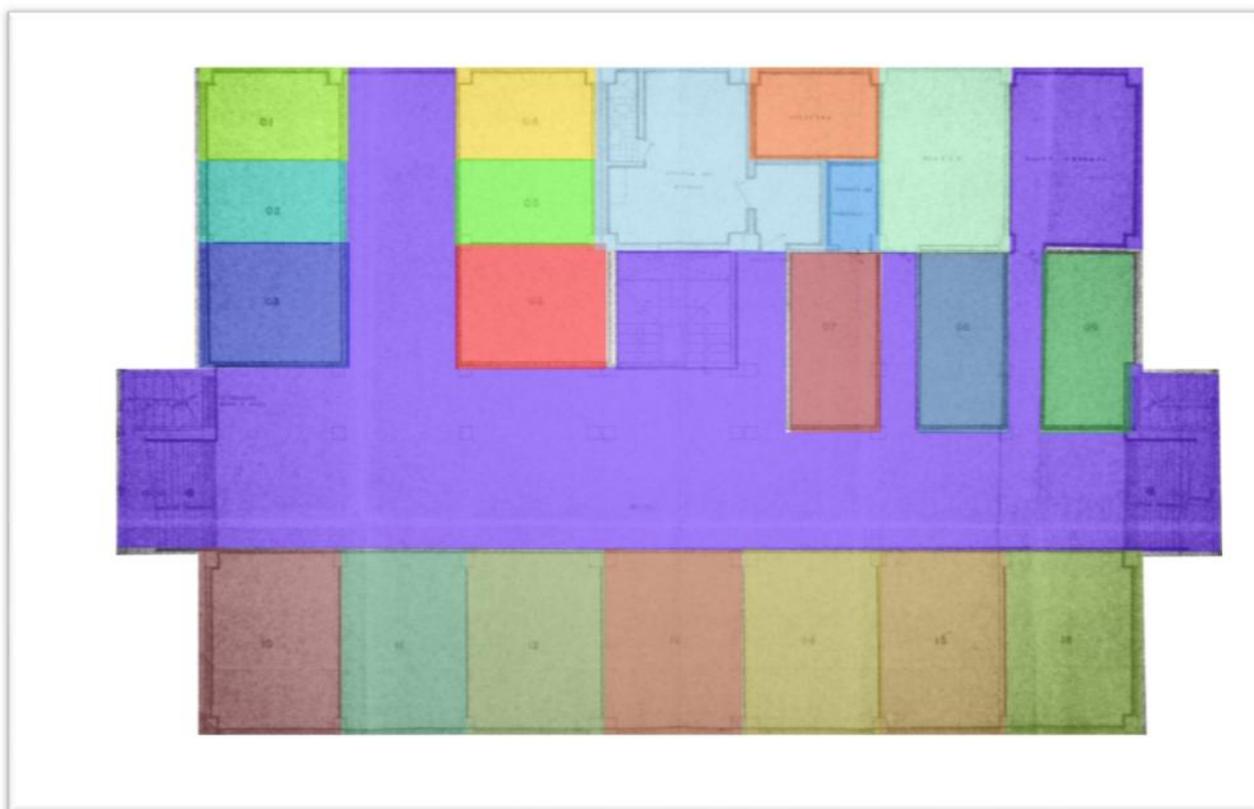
Planta del Proyecto - Subsuelo. Señalización de Espacios.
